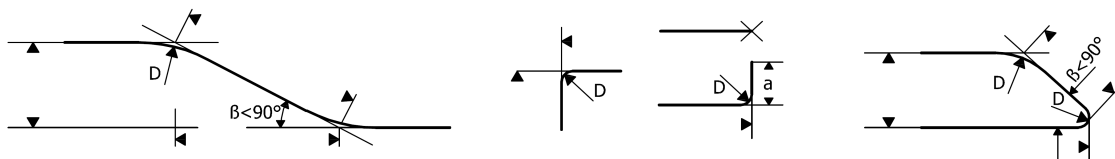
Dettaglio strati di armatura della fondazione
